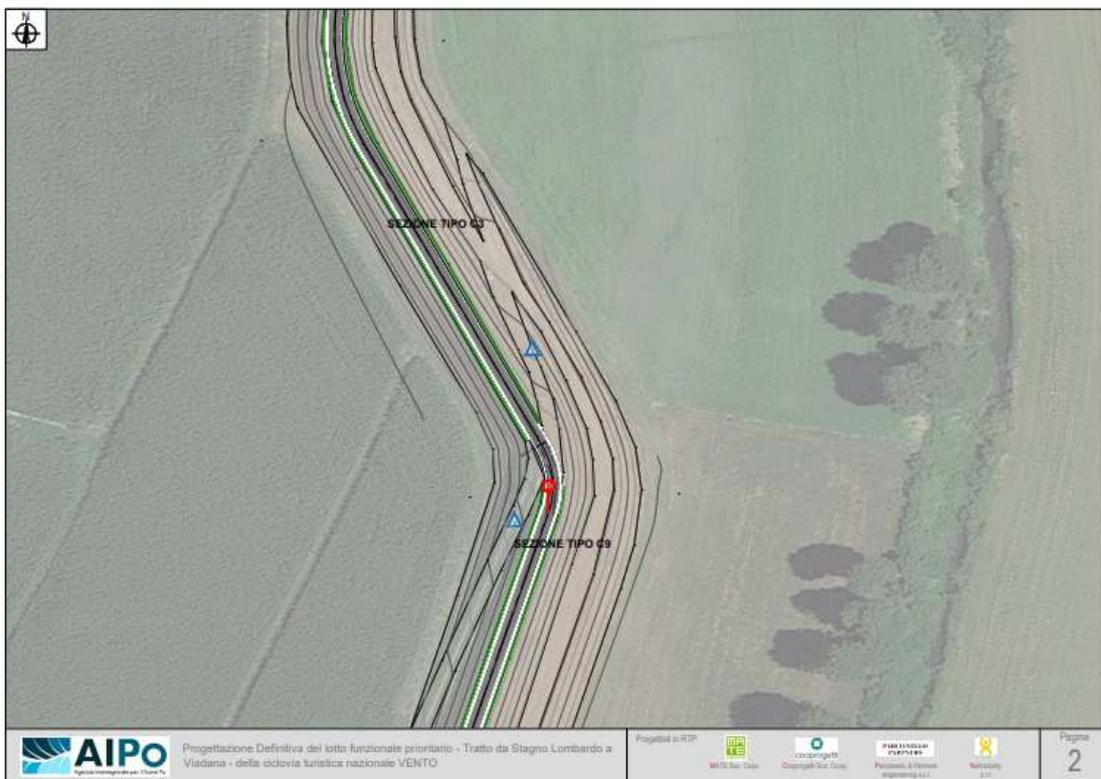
Tavola 2 Planimetria generale, da progetto MATE
